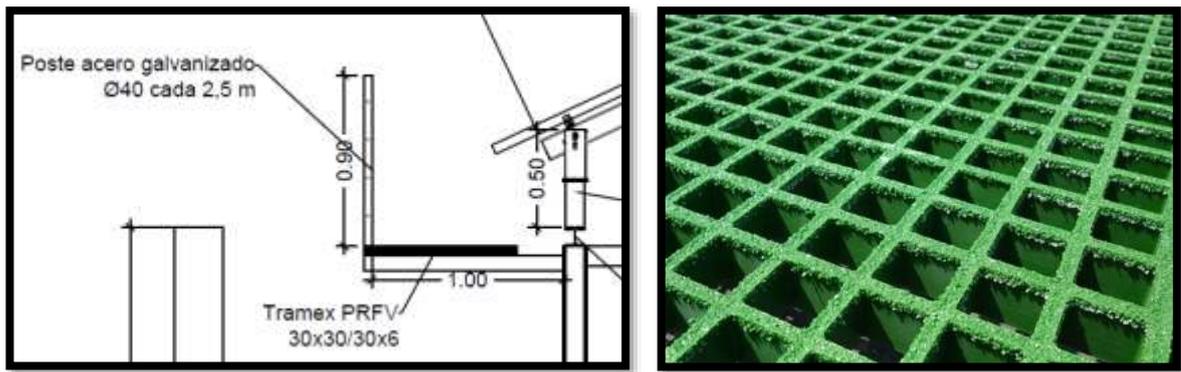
Esquema pasillo de acceso (izquierda) y material utilizado (derecha).
